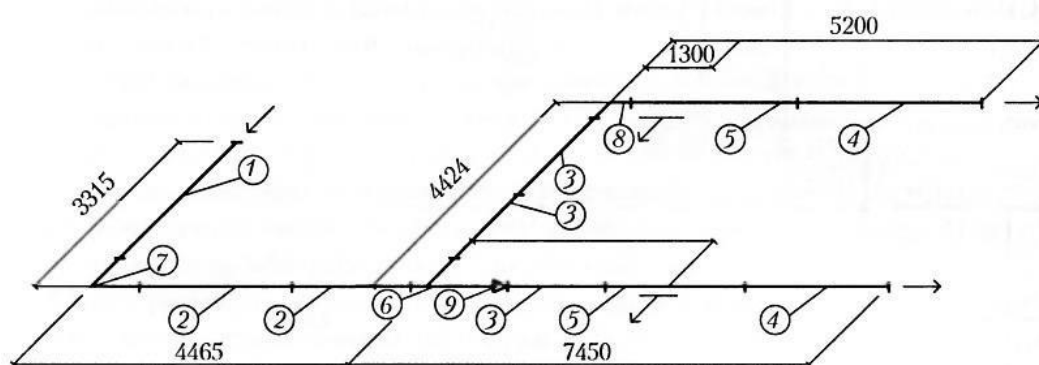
Фрагмент монтажной схемы воздухопроводов:
